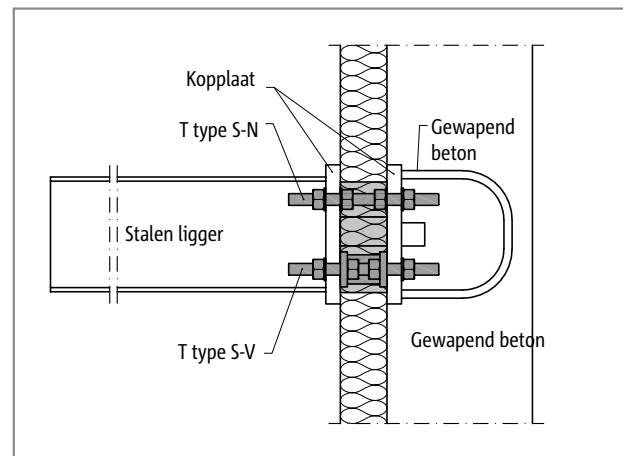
Schöck Isokorb® T type S: Buitenhoek
